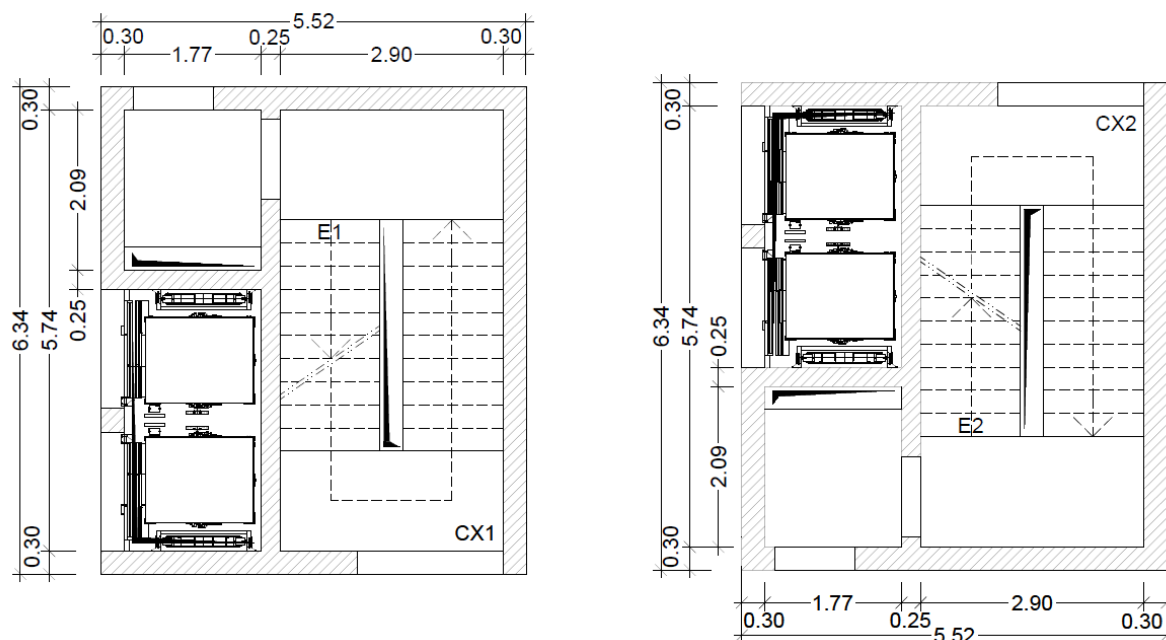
Representação em planta das caixas de elevador e de escadas
